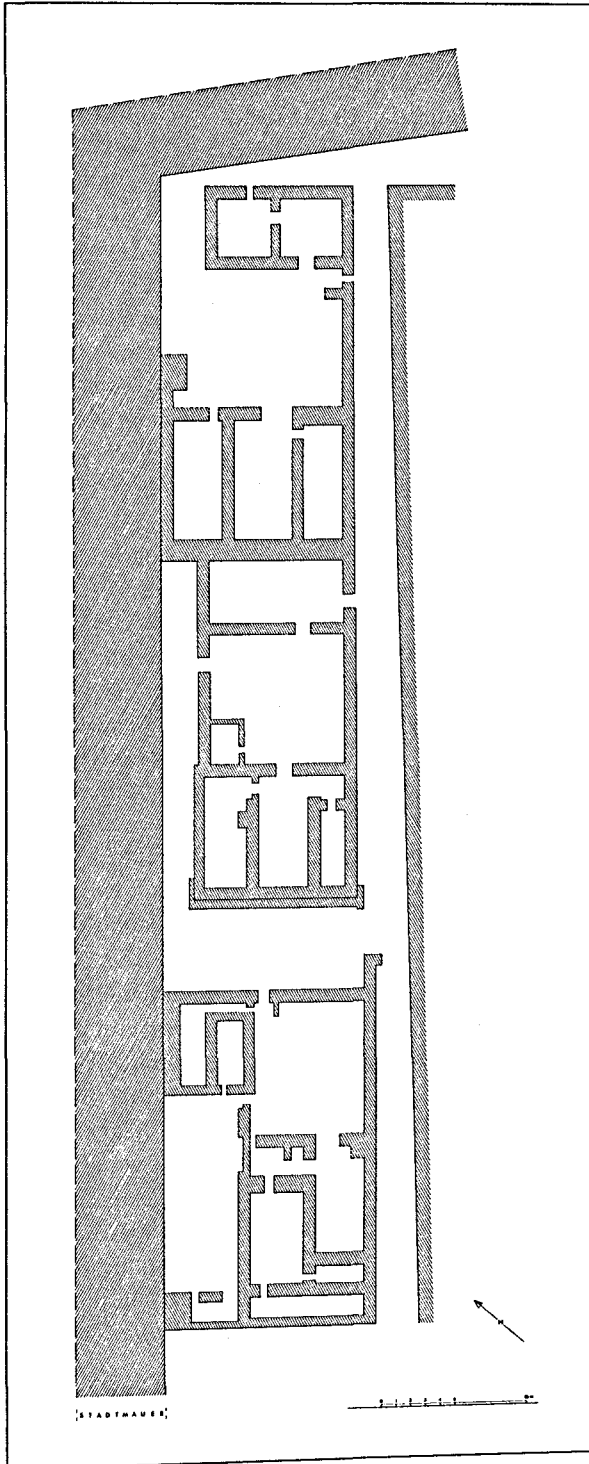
Ruqbat al-Madā'in. Grundrisse an der Stadtmauer
